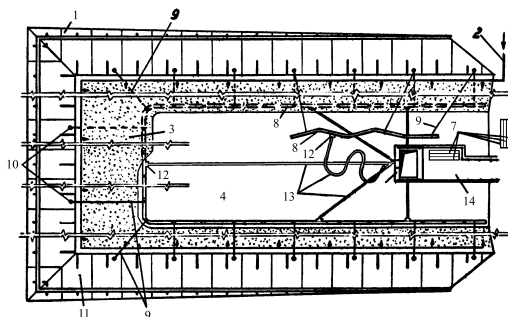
План хвостохранилища с размещением основных элементов дренажа
